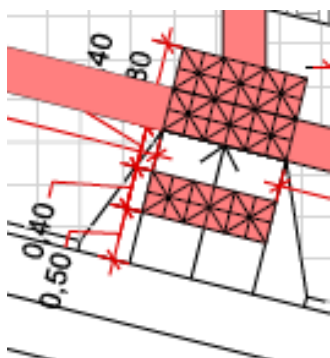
EXEMPLO DE REBAIXAMENTO DE CALÇADA, NO PROJETO
